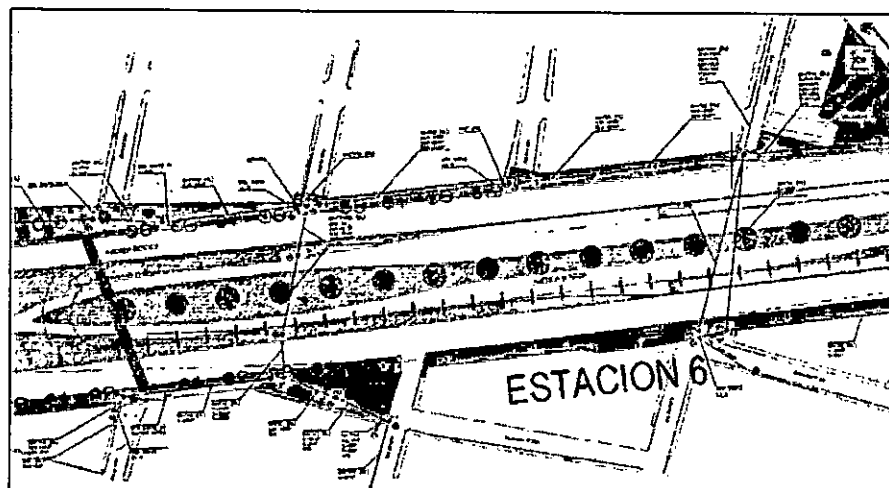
Plano tipo de levantamiento y digitalización de redes existentes de ETB.
